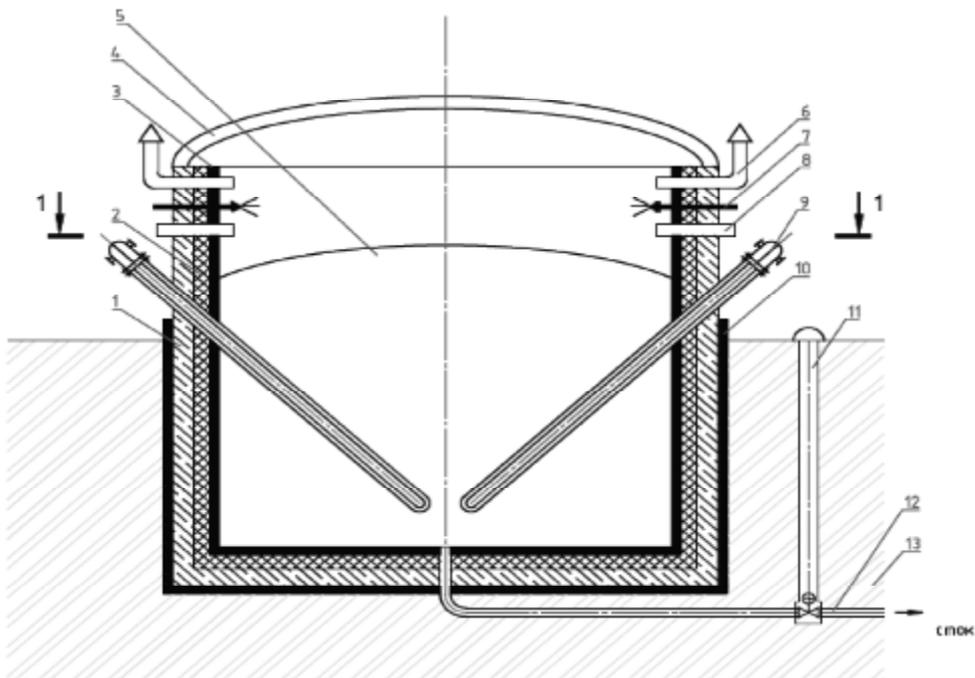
Конструкция аккумулятора холода на 100 МВтч с бетонным подземным резервуаром объемом 2000 м³: 1 – бетонный резервуар; 2 – слой теплоизоляции; 3 – внутренняя гидроизоляция резервуара; 4 – надувной сводчатый купол; 5 – ледяная масса; 6 – воздухоотбрасывающее устройство; 7 – форсунка; 8 – вентиляционные каналы; 9 – трубный пучок; 10 – наружная гидроизоляция; 11 – колодец с задвижкой на стоке; 12 – сток в канализацию; 13 – уплотнительный грунт
